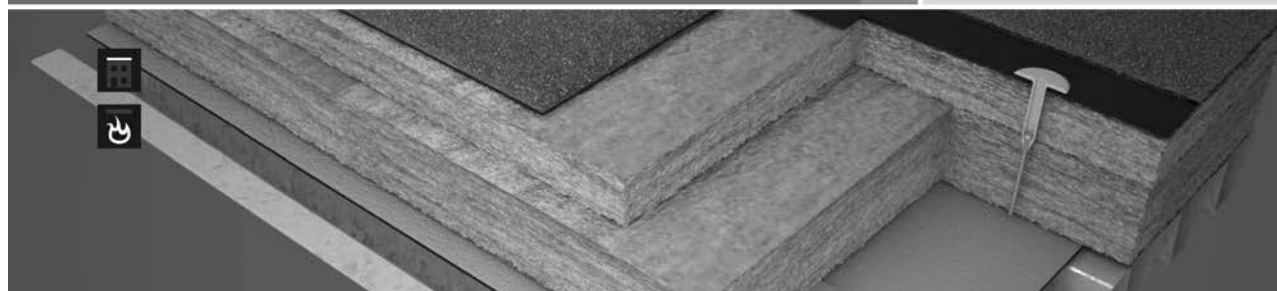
Detail u vtoku (skladba DEKROOF 14-B)
